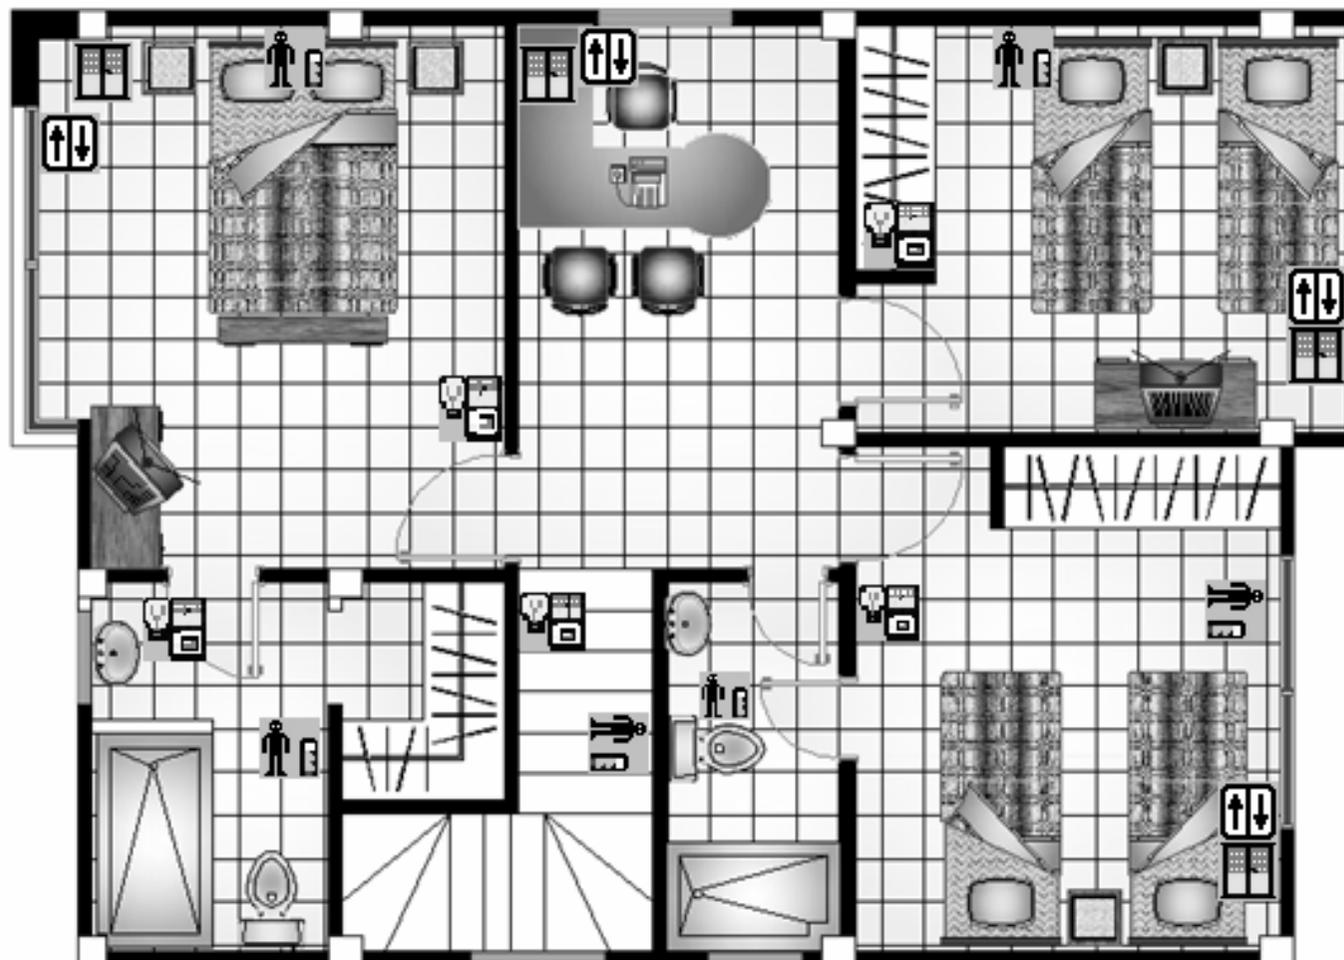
Sistema de Iluminación, Planta Alta, Plano Arquitectónico.
